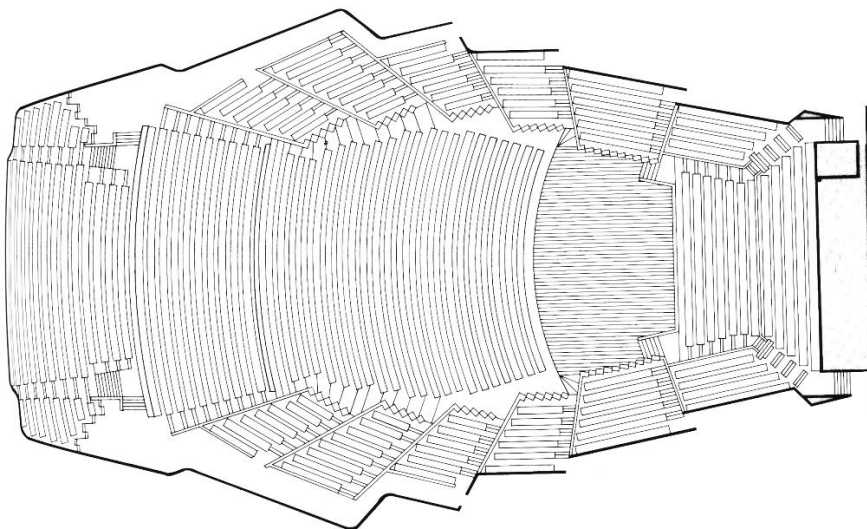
Grundriss Oper Sydney (Beranek 2004, S. 167)
